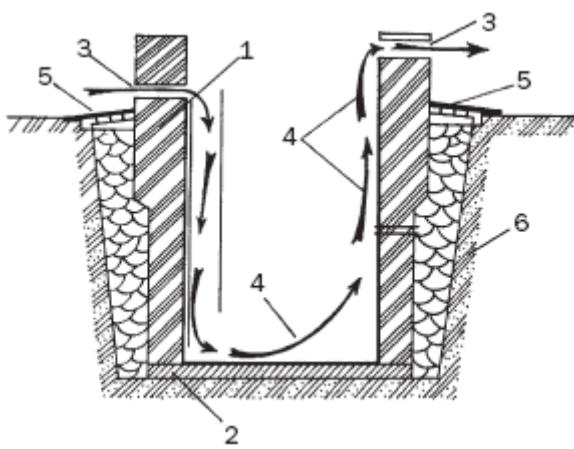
Вентилирование подвального помещения: 1 – стены; 2 – пол; 3 – разноуровневые
